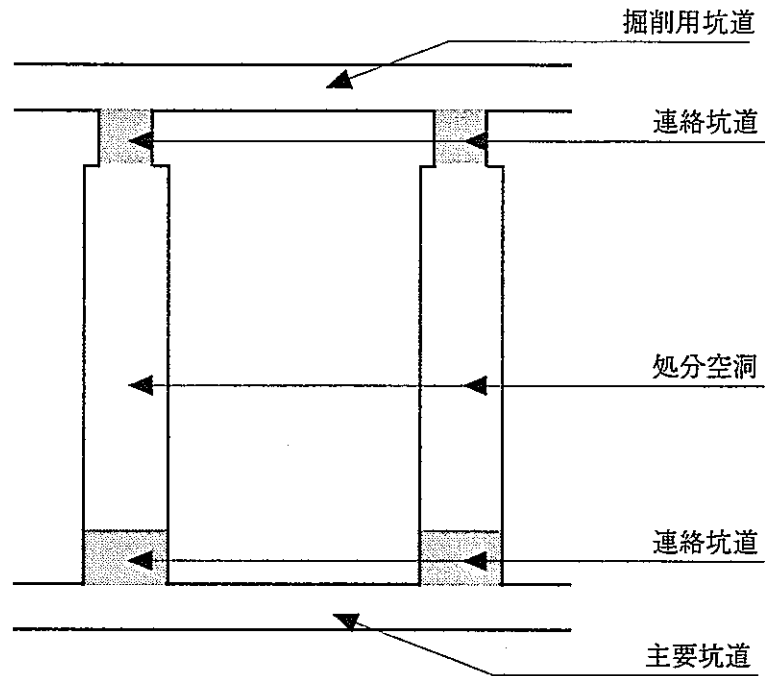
大断面岩洞方式 連絡坑道断面図
